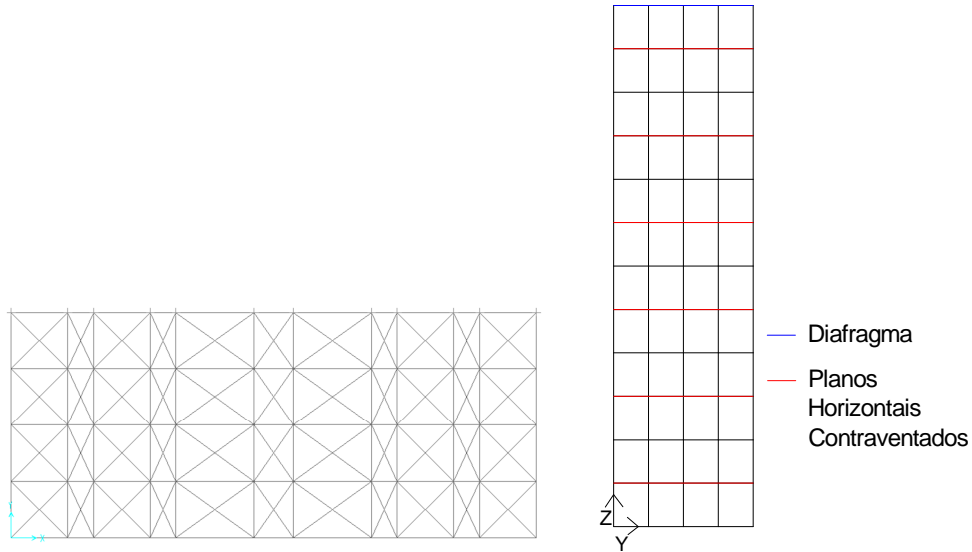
Configuração dos Planos de Contraventamento Horizontal Com Elementos de Contraventamento Pequenos
